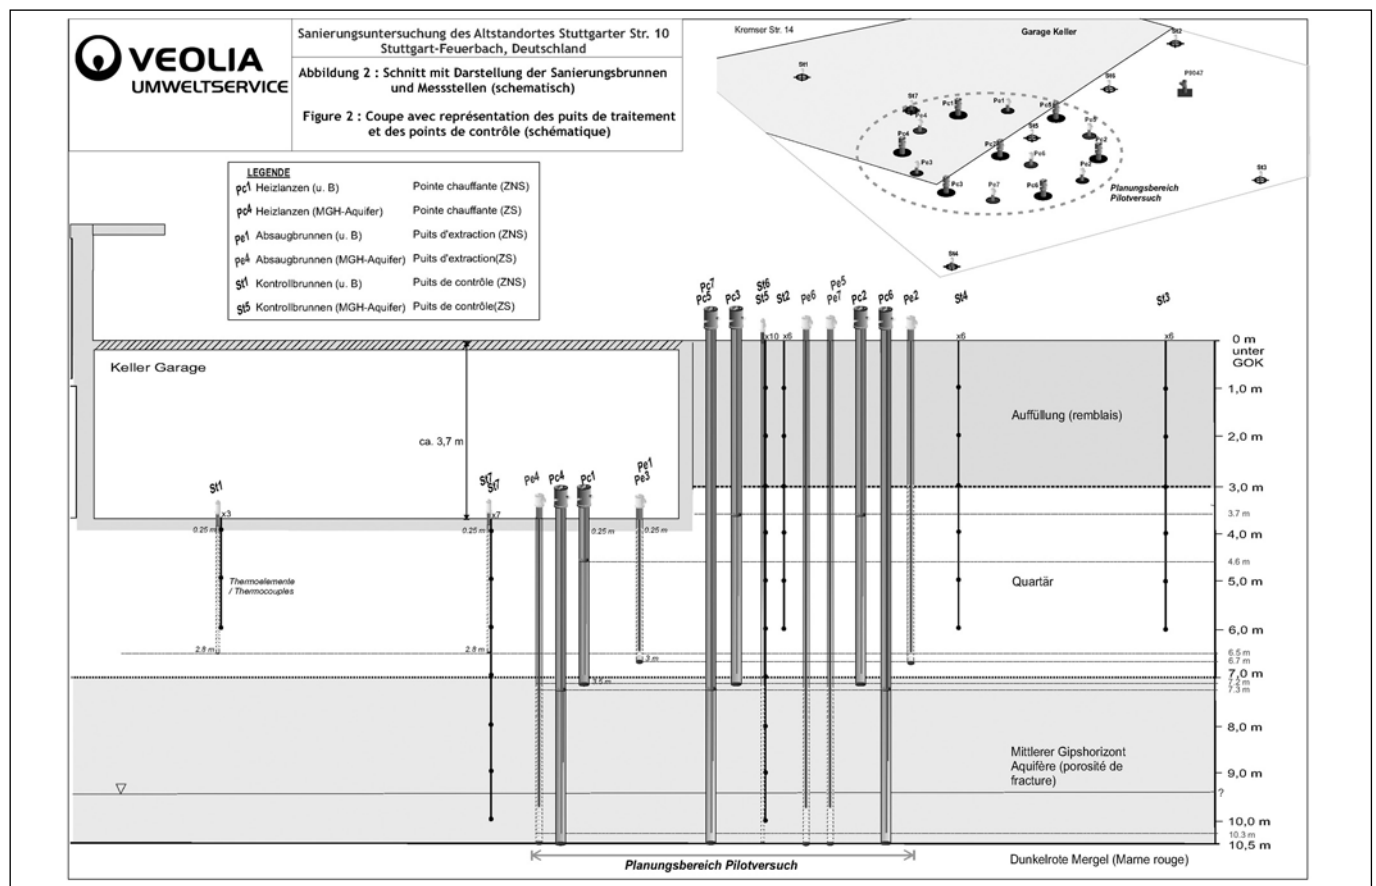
Darstellung der Sanierungsbrunnen und Messstellen. Quelle: Landeshauptstadt Stuttgart.
